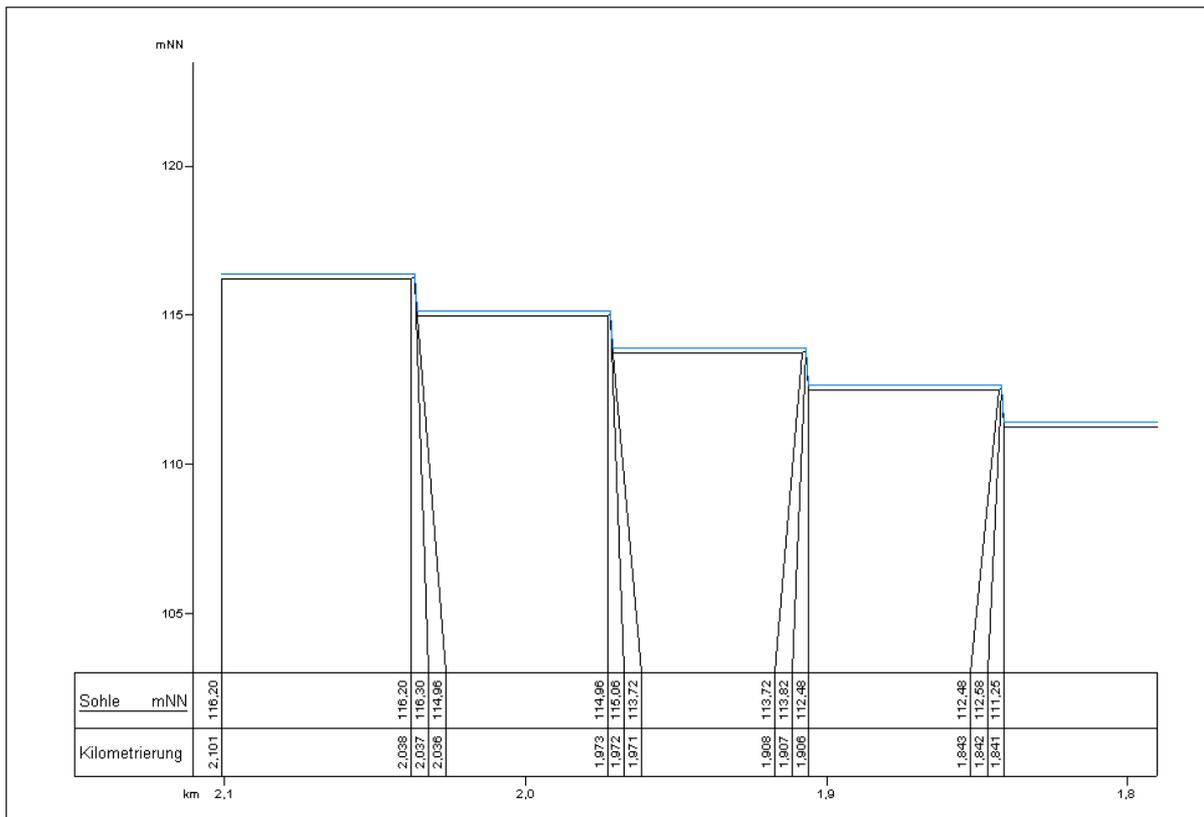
Längsschnitt Abschnitt 1 mit Mittelwasserabfluss
